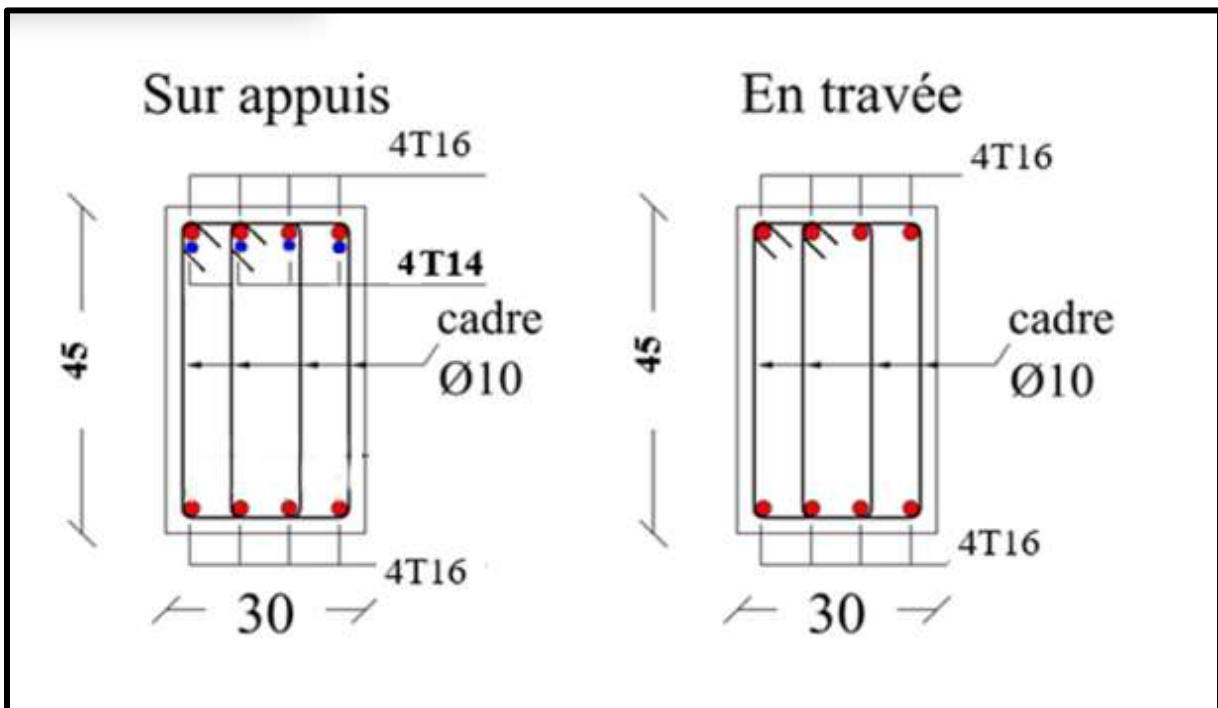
Ferrailage de la poutre principale (Zone 02)
